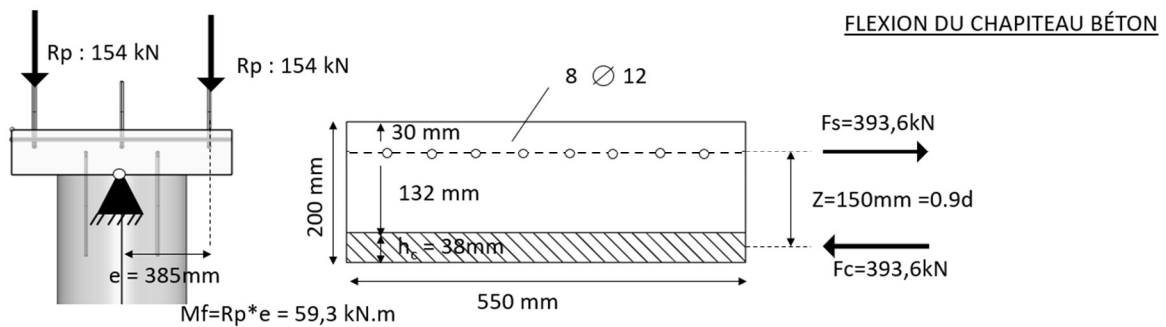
Exemple d'assemblage en console avec pièce rapportée en béton
